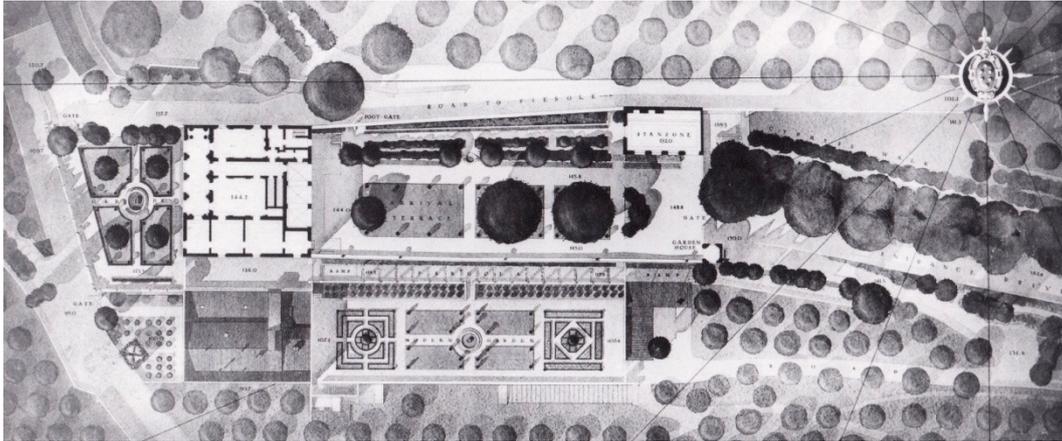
N. T. Newton: rekonstruierter Grundriss der Villa Medici in Fiesole, o.J., o.A.
